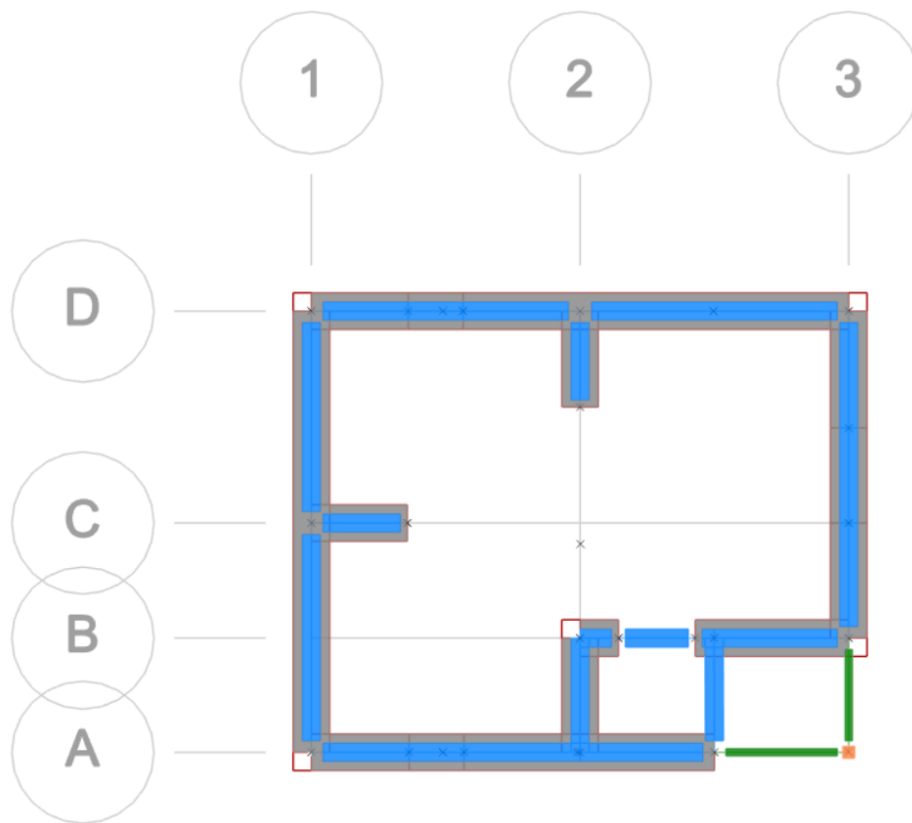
Modelamiento estructural en planta – vivienda de adobe.
